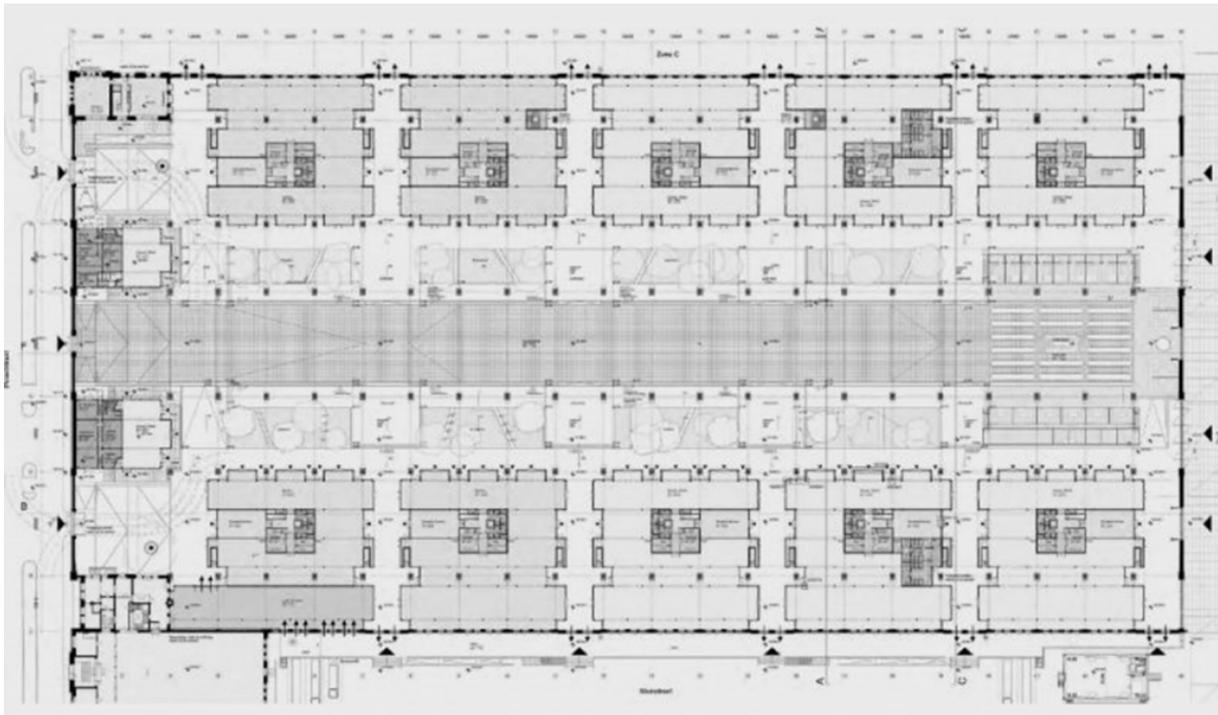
10 Blöcke und 2 Kopfbauten im Grundriss (Quelle: Extensa)
